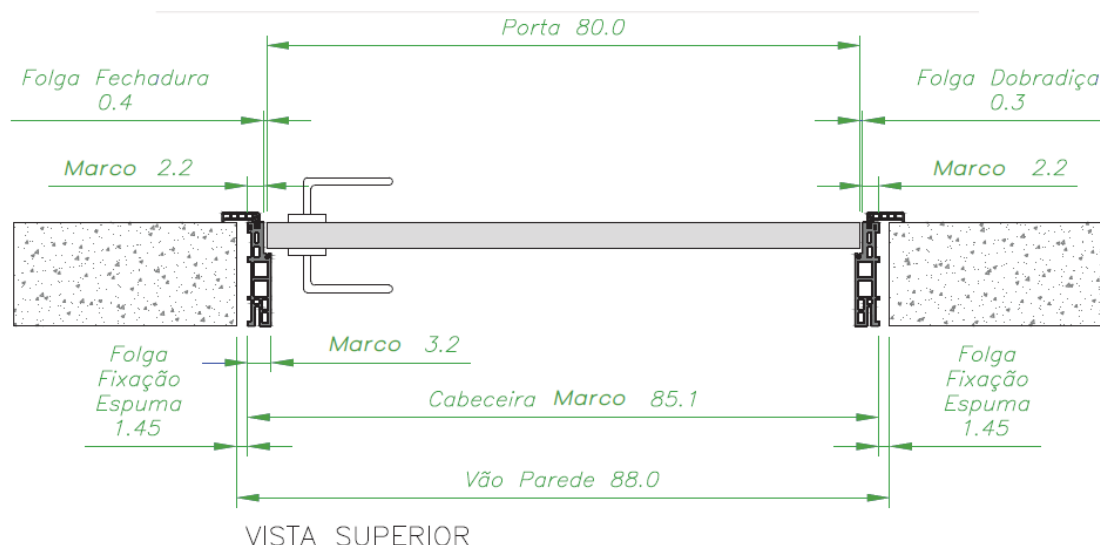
Vista superior do kit porta pronta com marco de “PVC Wood” incluindo dimensões e folgas para instalação (dimensões em cm).
